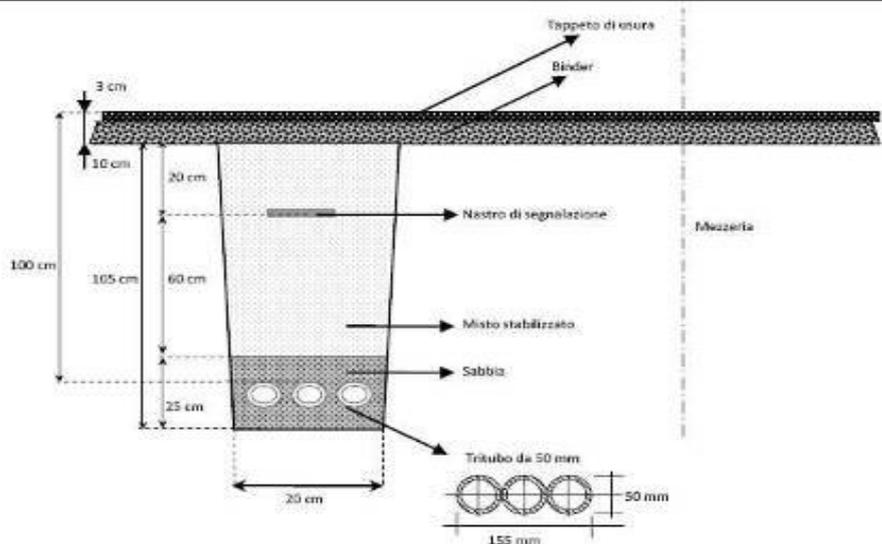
Sezione tipo scavo in trincea su sede stradale.
